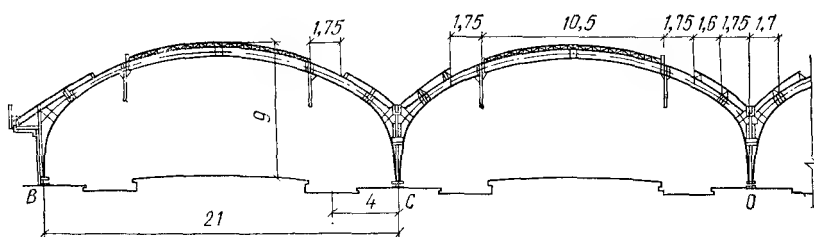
Многопролетная арка перекрытия вокзальных перронов
